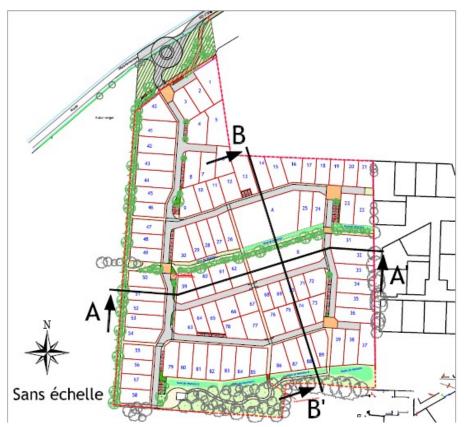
Plan masse du lotissement "Les Hauts de Ty Nehué"
